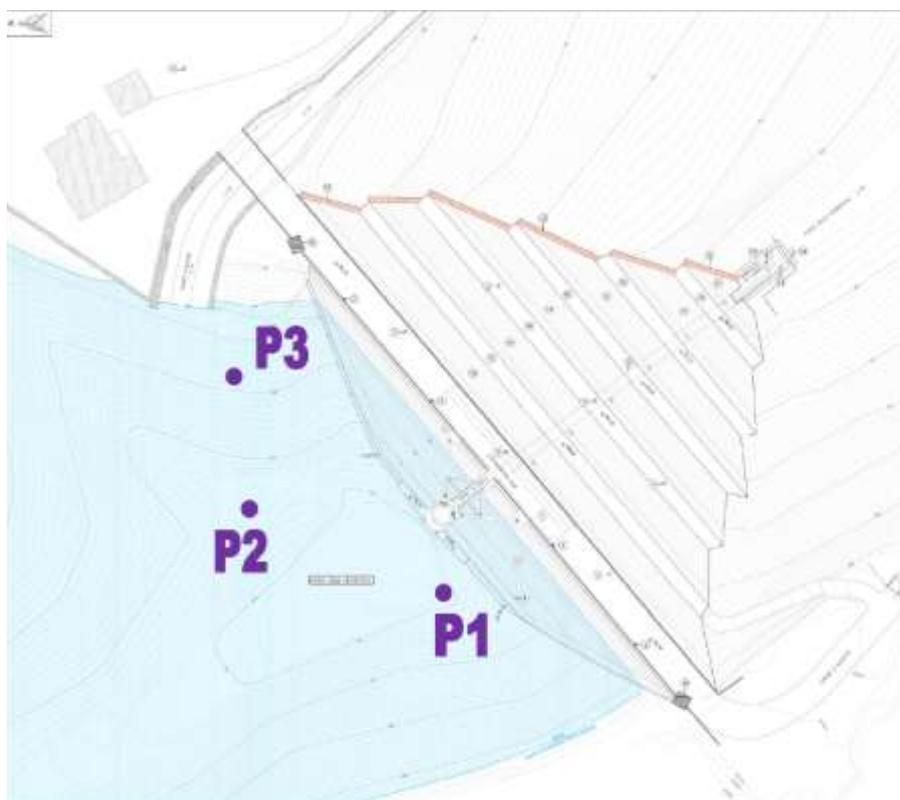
estratto planimetria ubicazione dei punti di campionamento
